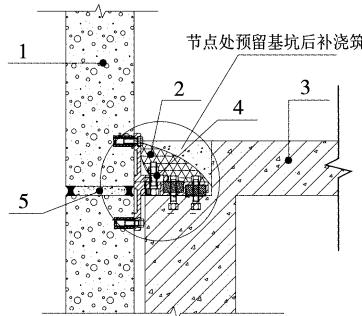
混凝土框架结构节点连接处防火构造示意图
